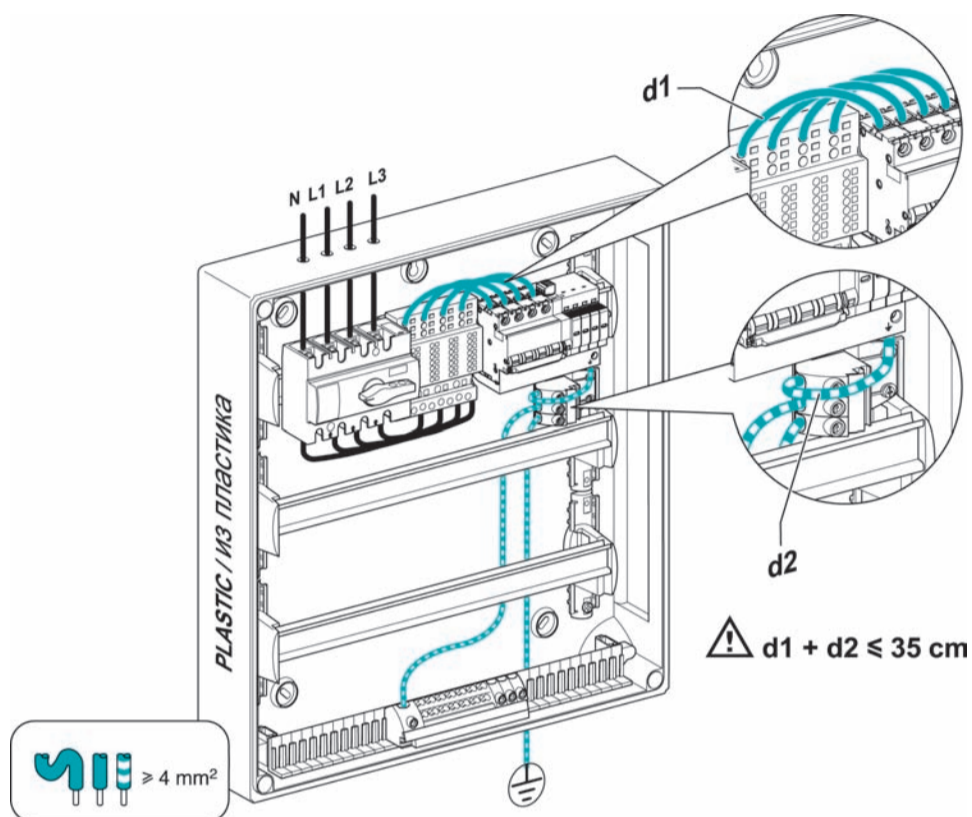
Installazione in quadro in materiale isolante di un SPD di Tipo 2 con protezione dalle sovracorrenti integrata
